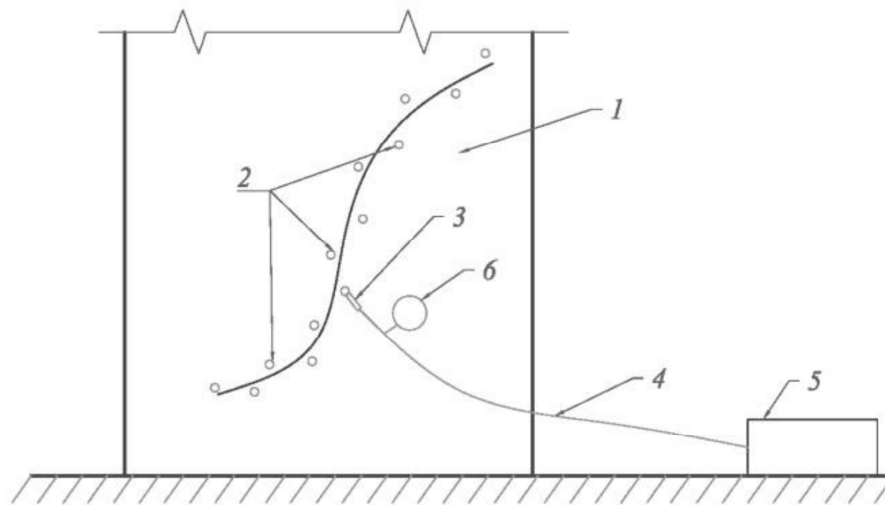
Принципова схема ін'єкування тріщин. 1 – конструкція, що підлягає ремонту; 2 – отвори під пакери вздовж тріщини; 3 – ін'єкційний пакер; 4 – трубка для подачі ремонтного розчину; 5 – пристрій для подачі розчину під тиском; 6 – манометр
